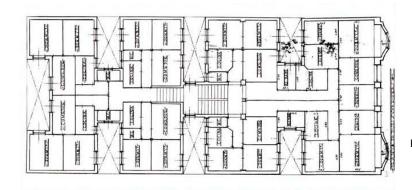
Edificio de viviendas en la calle Ibiza, Madrid Planta tipo, 1927
